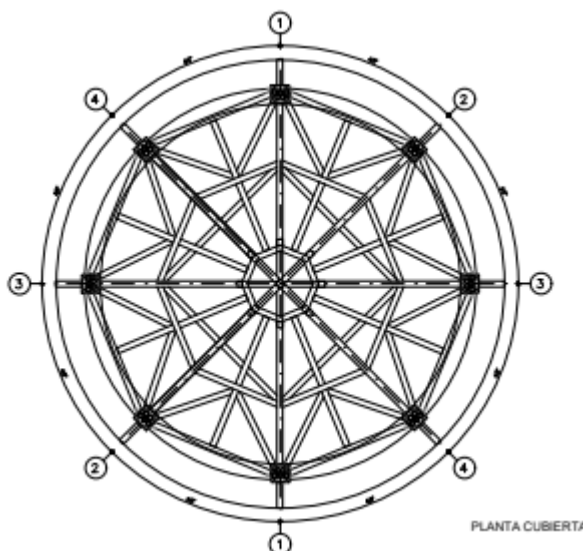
Elementos principales de la estructura de la cubierta. Fuente: Elaboración propia
